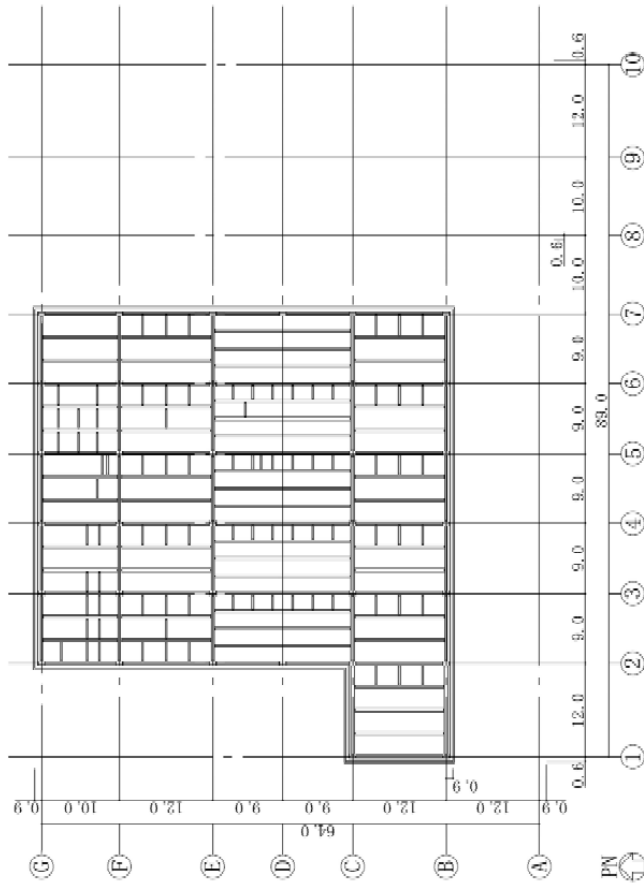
屋上階平面図 (G.L.+12.3) (単位 : m)
